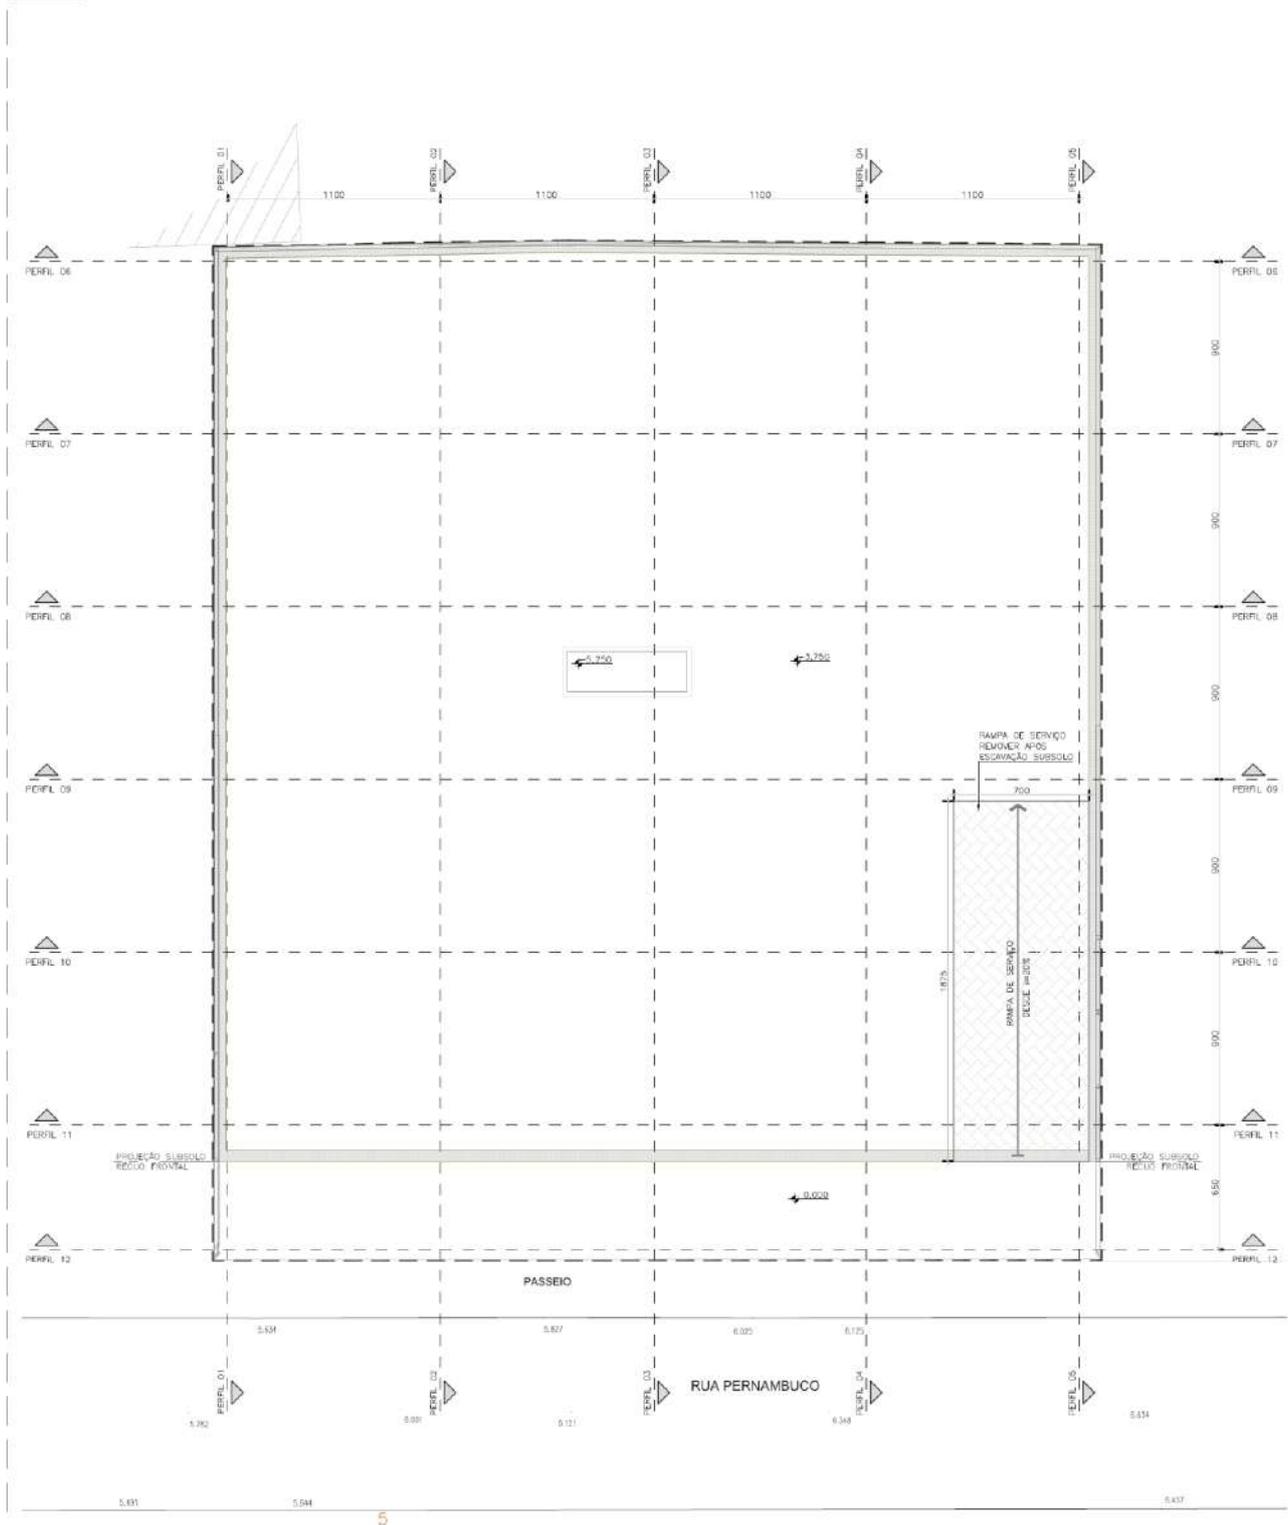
Planta baixa terreno terraplanado. FONTE: Projeto de Terraplanagem 2P Engenharia.
